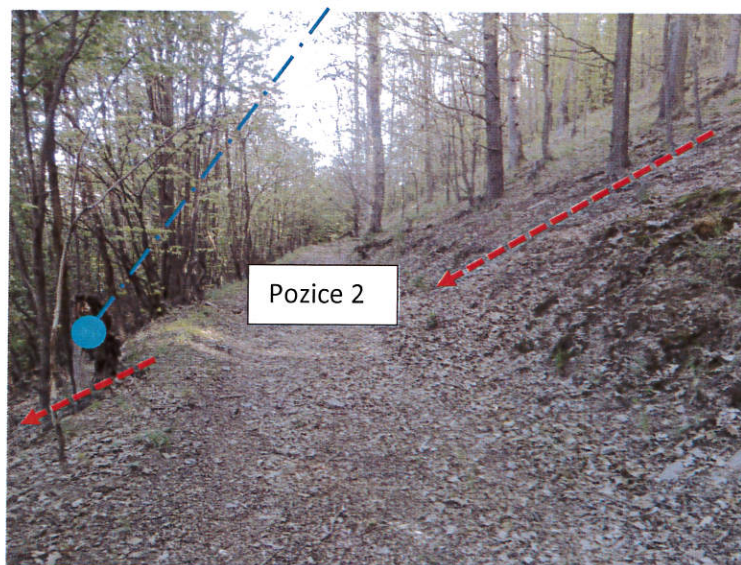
lesní cesta s kótou cca 295 m n.m.
